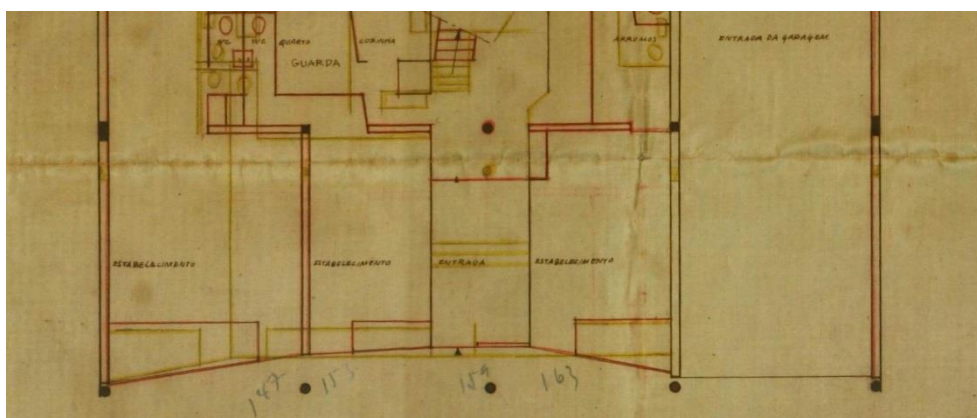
Estrutura embutida nas paredes à excepção do pilar na zona de entrada do edifício.
